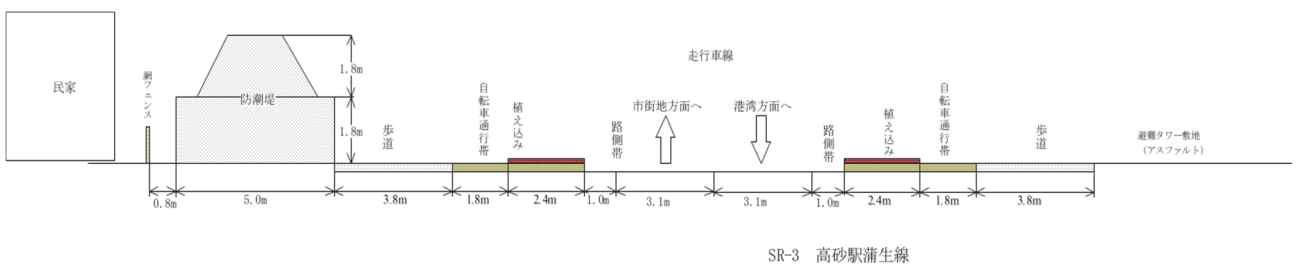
(3) 道路断面図 (AR-3 高砂駅蒲生線)
